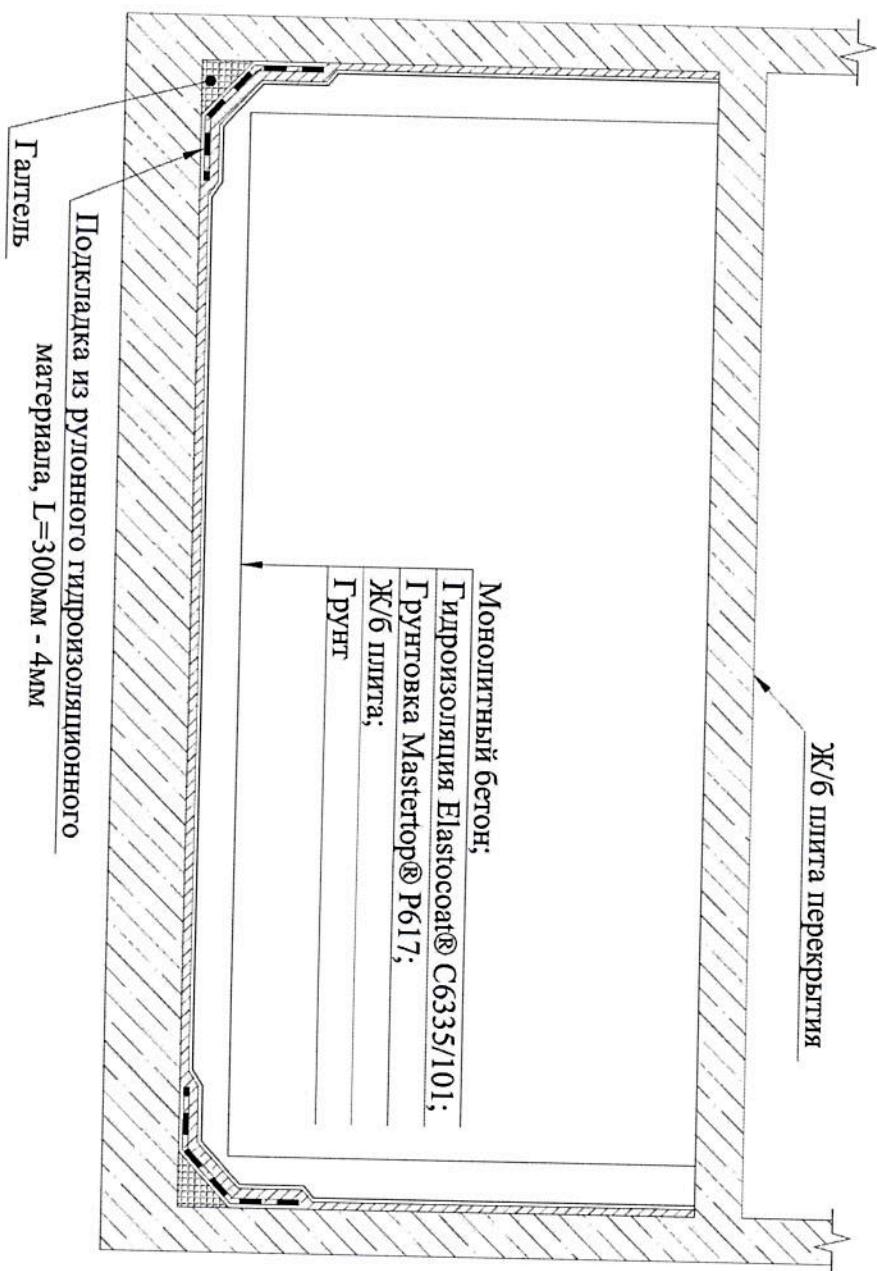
Конструктивное решение внутренней гидроизоляции подвалов гражданских зданий со стенами из железобетона
